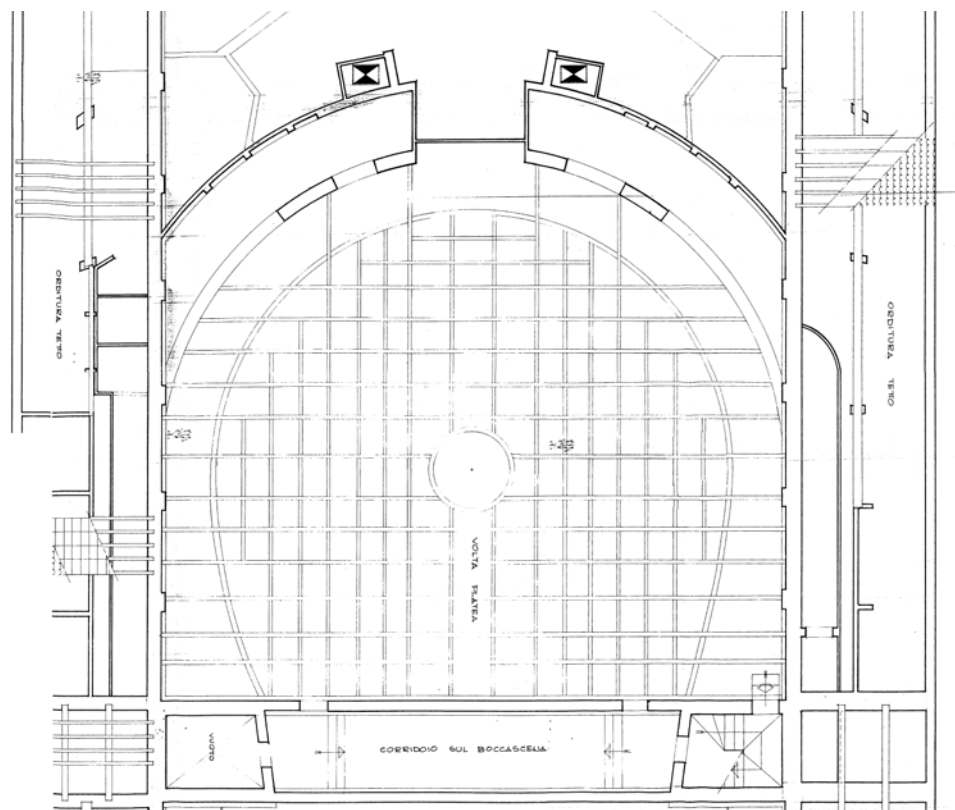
Pianta del plafone della sala (A.S.B.A.P.Bo., MO M 373 (II). Progetto per il miglioramento statico dei fabbricati danneggiati dal sisma del maggio 1987. Elaborati grafici).
